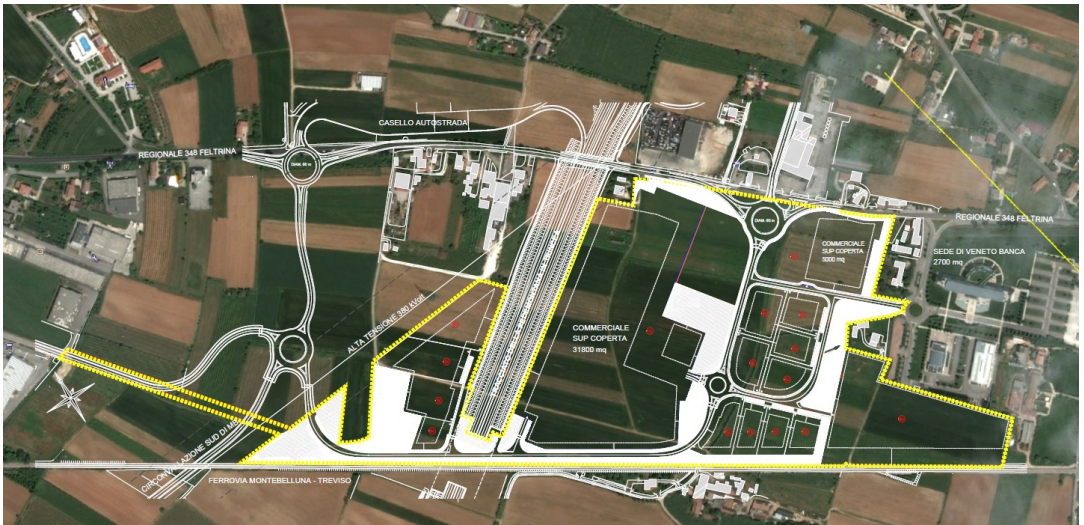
Planimetria del Piano Particolareggiato adottato dalla Giunta Comunale, con indicato in giallo il perimetro dell'area di intervento.
